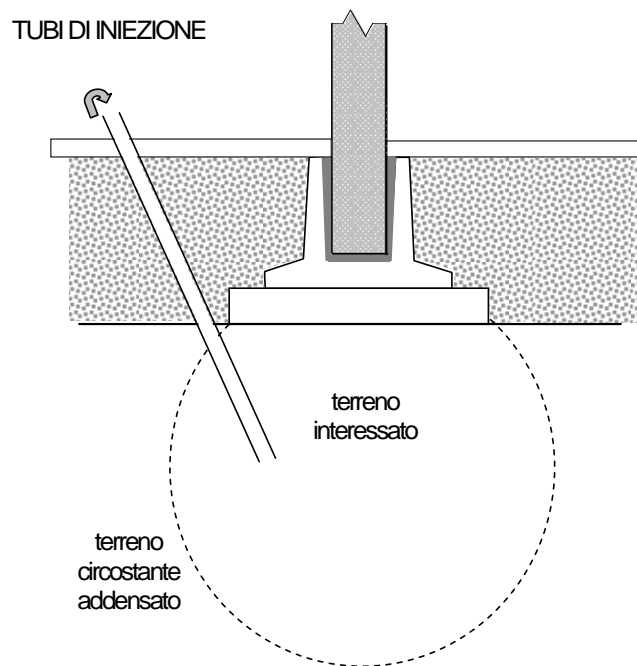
Iniezioni inclinate sotto le fondazioni esistenti, eseguite dall'esterno dell'edificio industriale.
